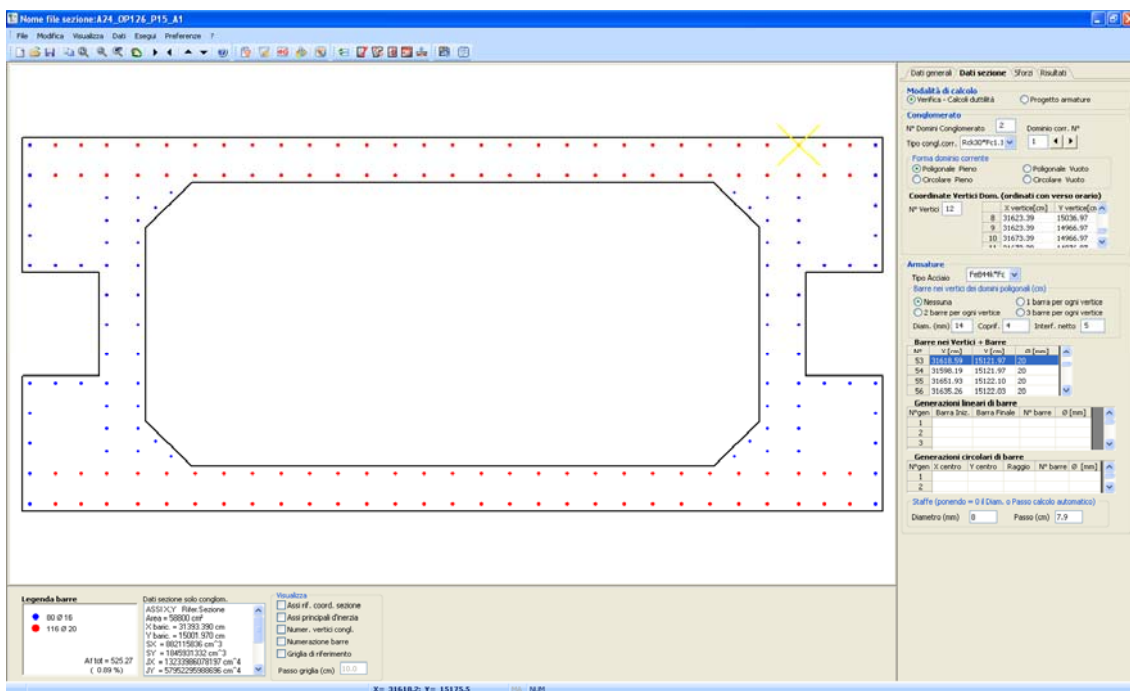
Armatura longitudinale di sezione 1 ($116\Phi 20+80\Phi 16$);
